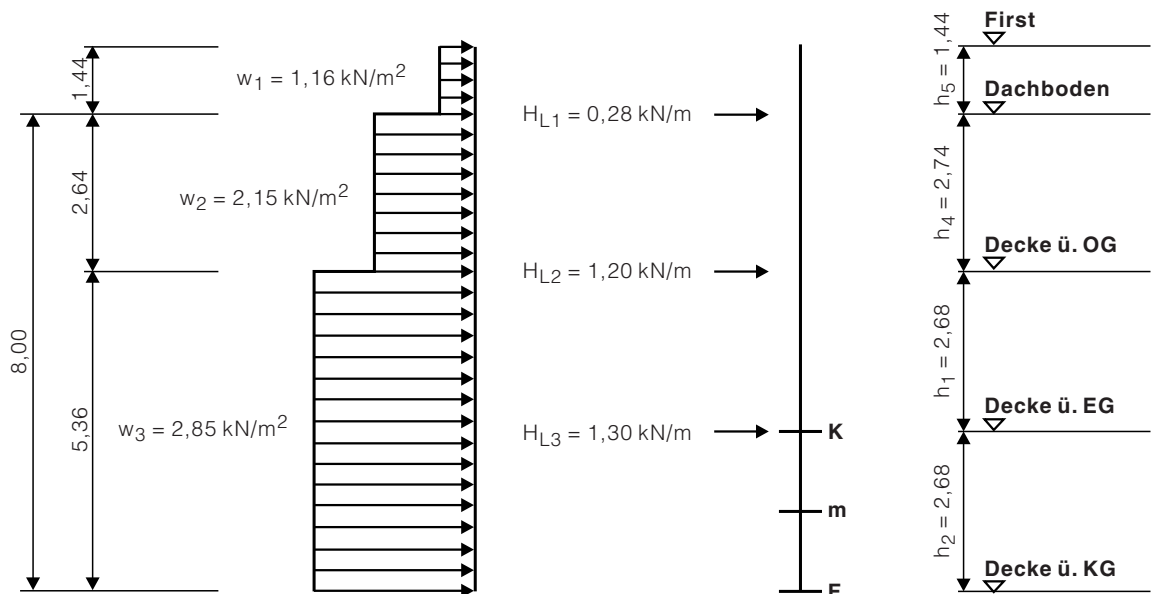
Horizontallasten aus Wind und Lotabweichung pro m Wandlänge
